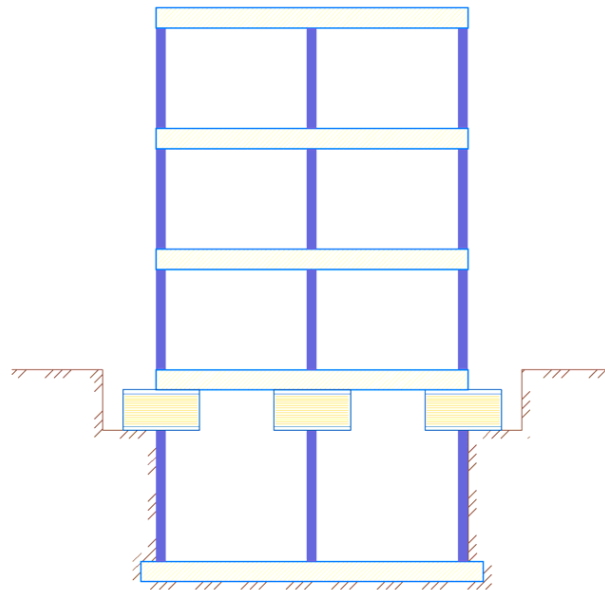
Ubicación de aisladores sísmicos en la parte superior de las columnas del sótano.
